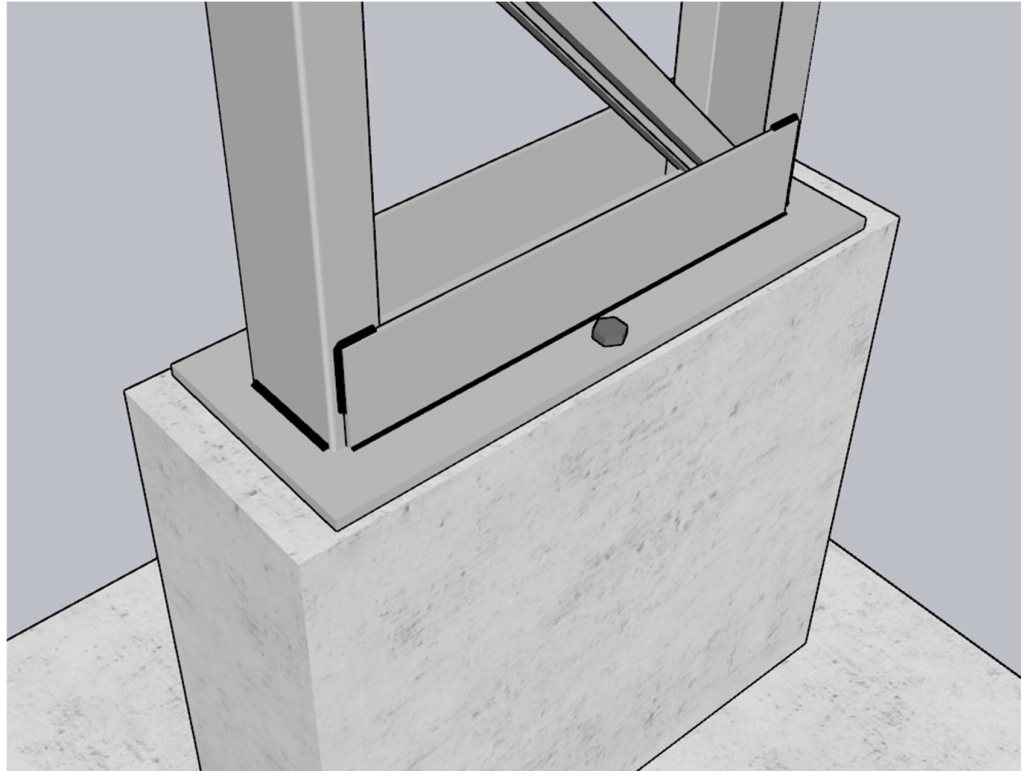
| Esquemas 3D de la unión pilar - fundación. Fuente: Elaboración propia.
